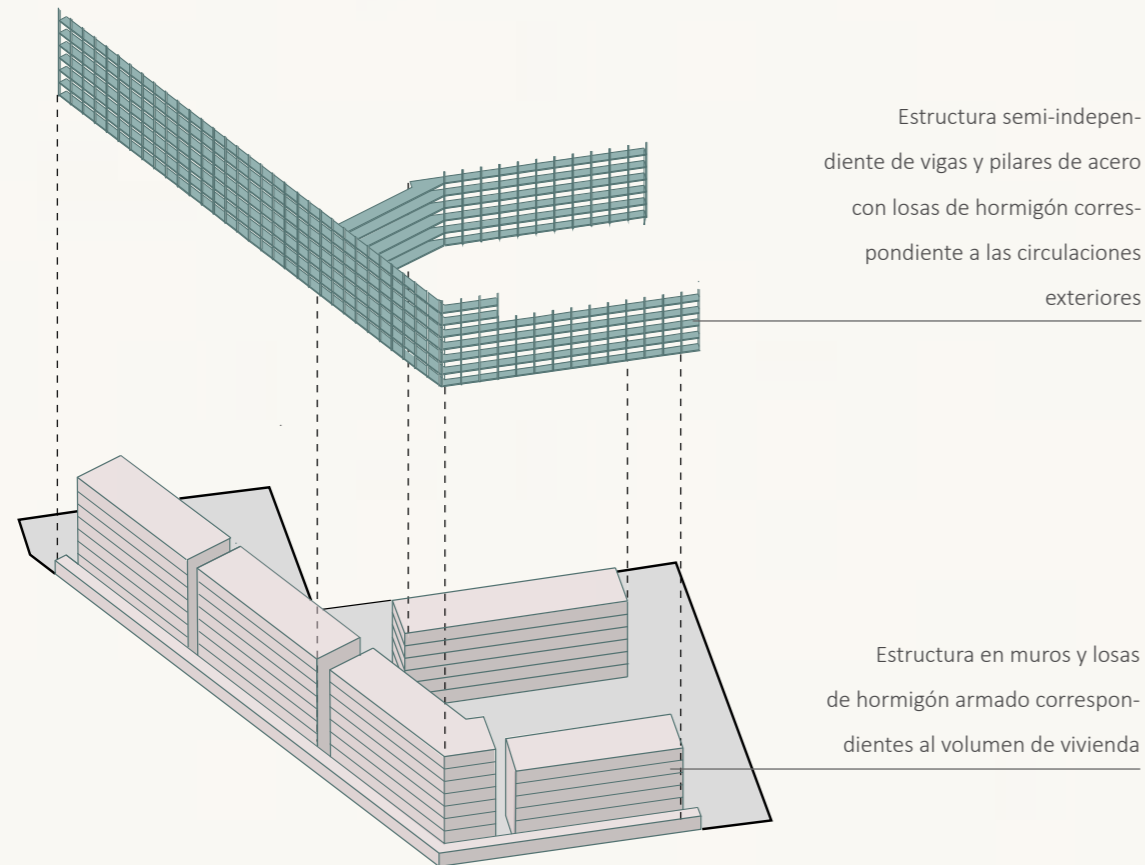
Esquema de propuesta estructural | Fuente: Elaboración propia
